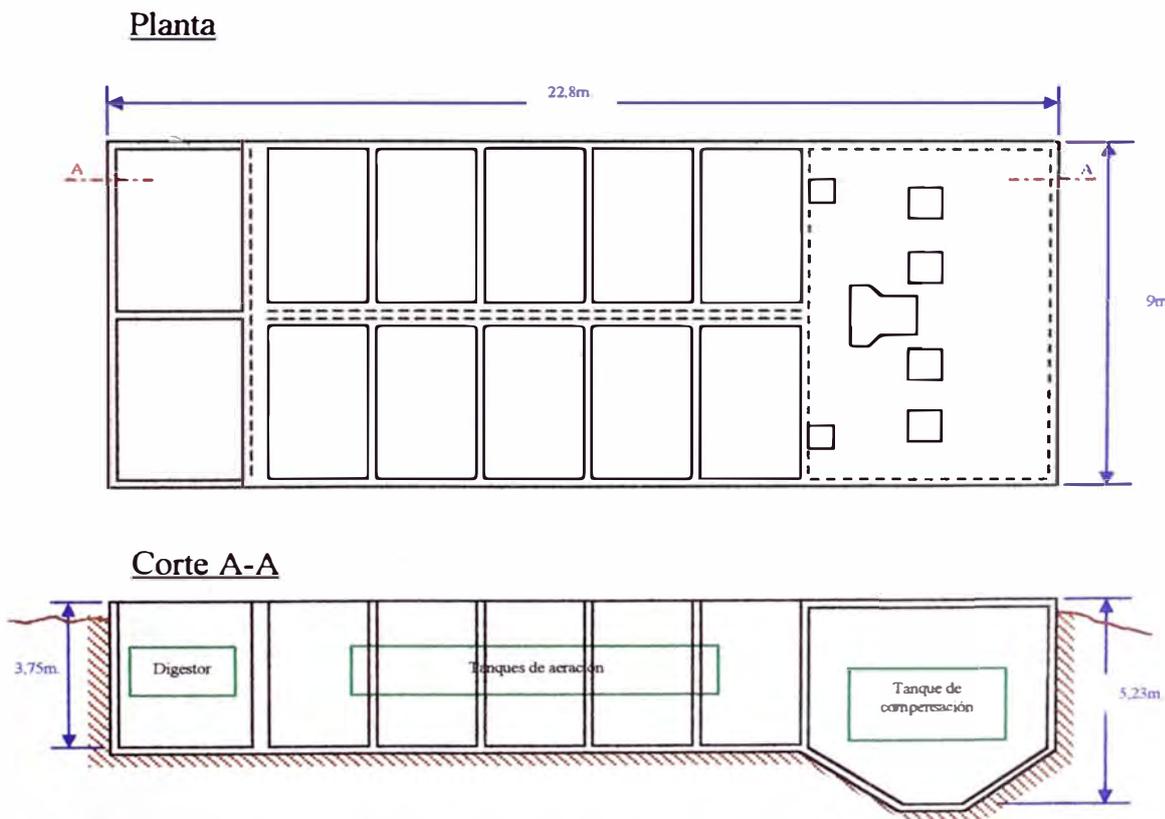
Planta y corte de pozas de tratamiento de desagües.
